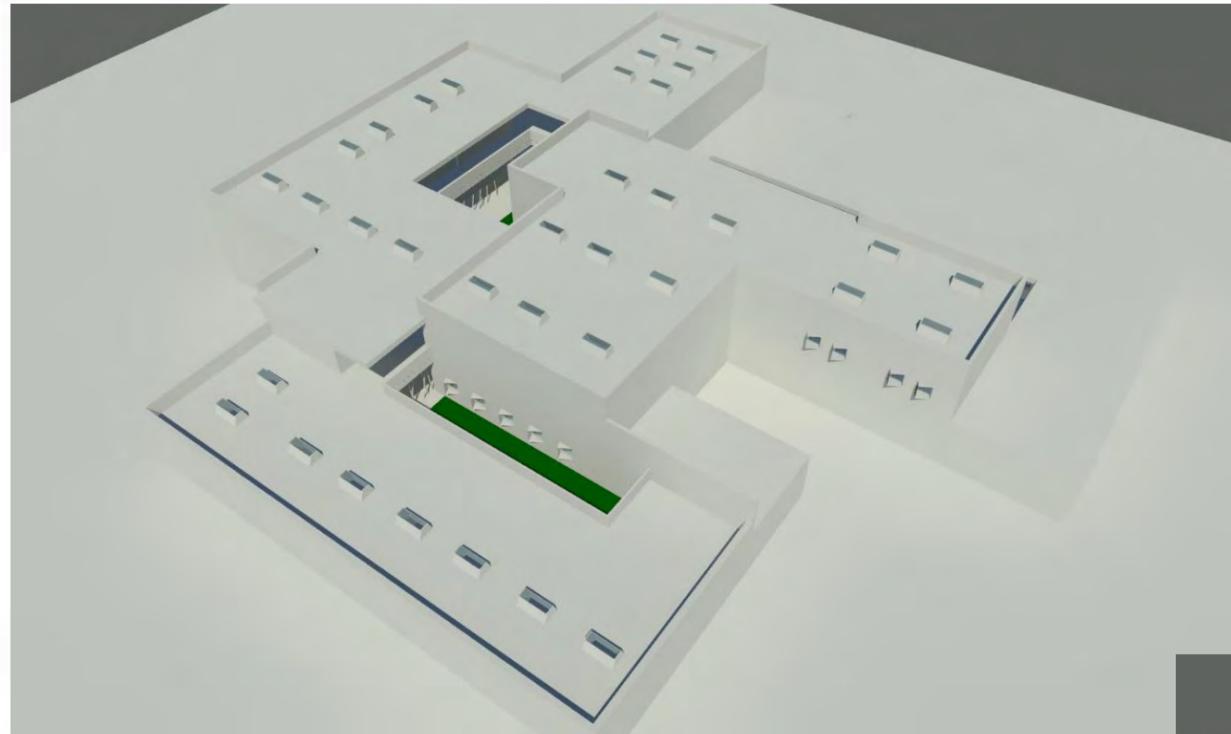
Anteproyecto Perspectiva aérea fachada sur.
